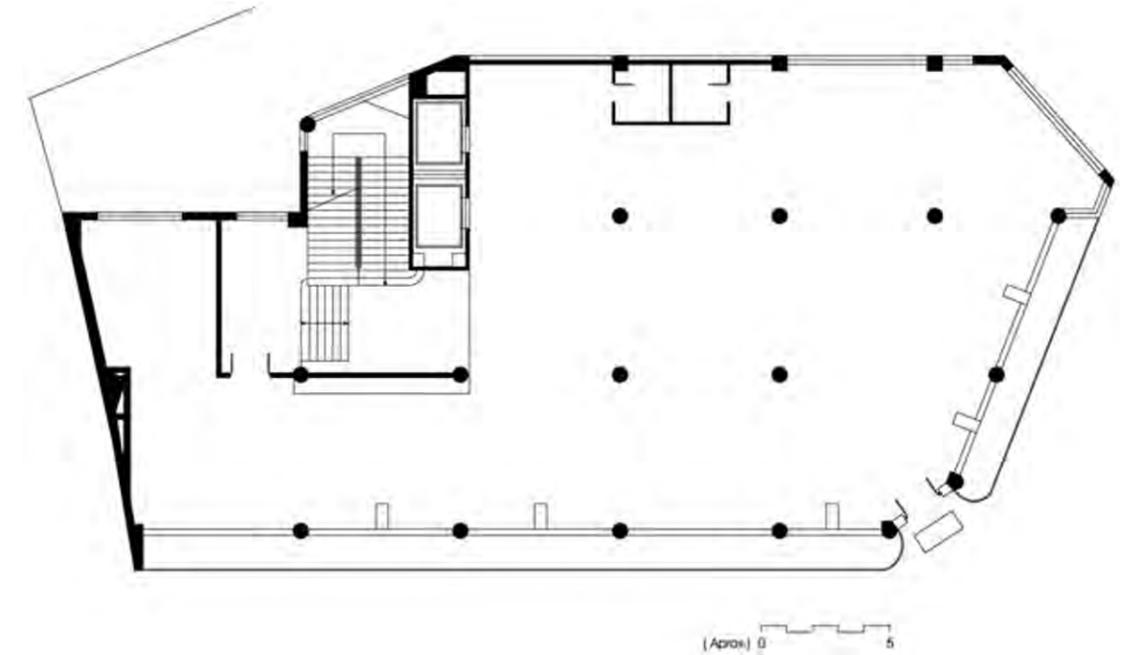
Reinterpretación de la planta de la tienda Bat'a en Bratislava (dibujo del autor).
